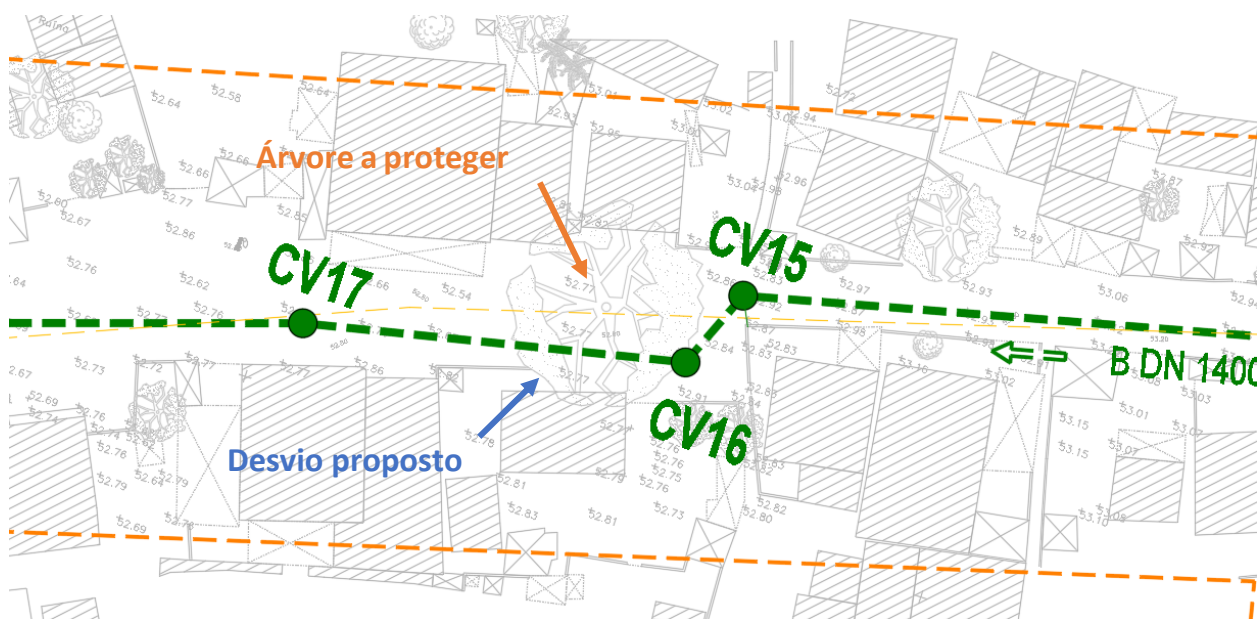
Condicionante – Desvio do colector na rua 2233 por proteger árvore relevante existente (Planta e perfil)
